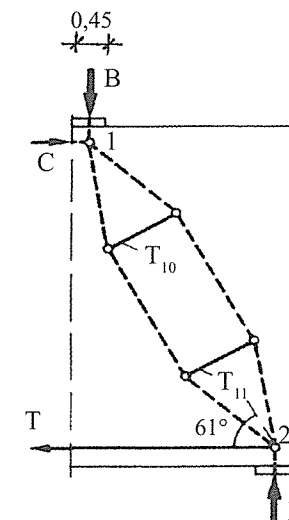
Modèle B-T (affiné) de la partie droite de la poutre-voile :
